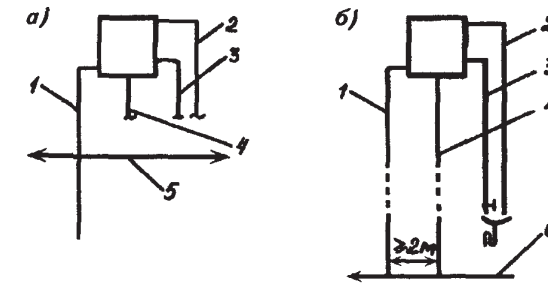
Схеми приєднання відкритого розширювального бака до трубопроводів системи водяного опалення:
